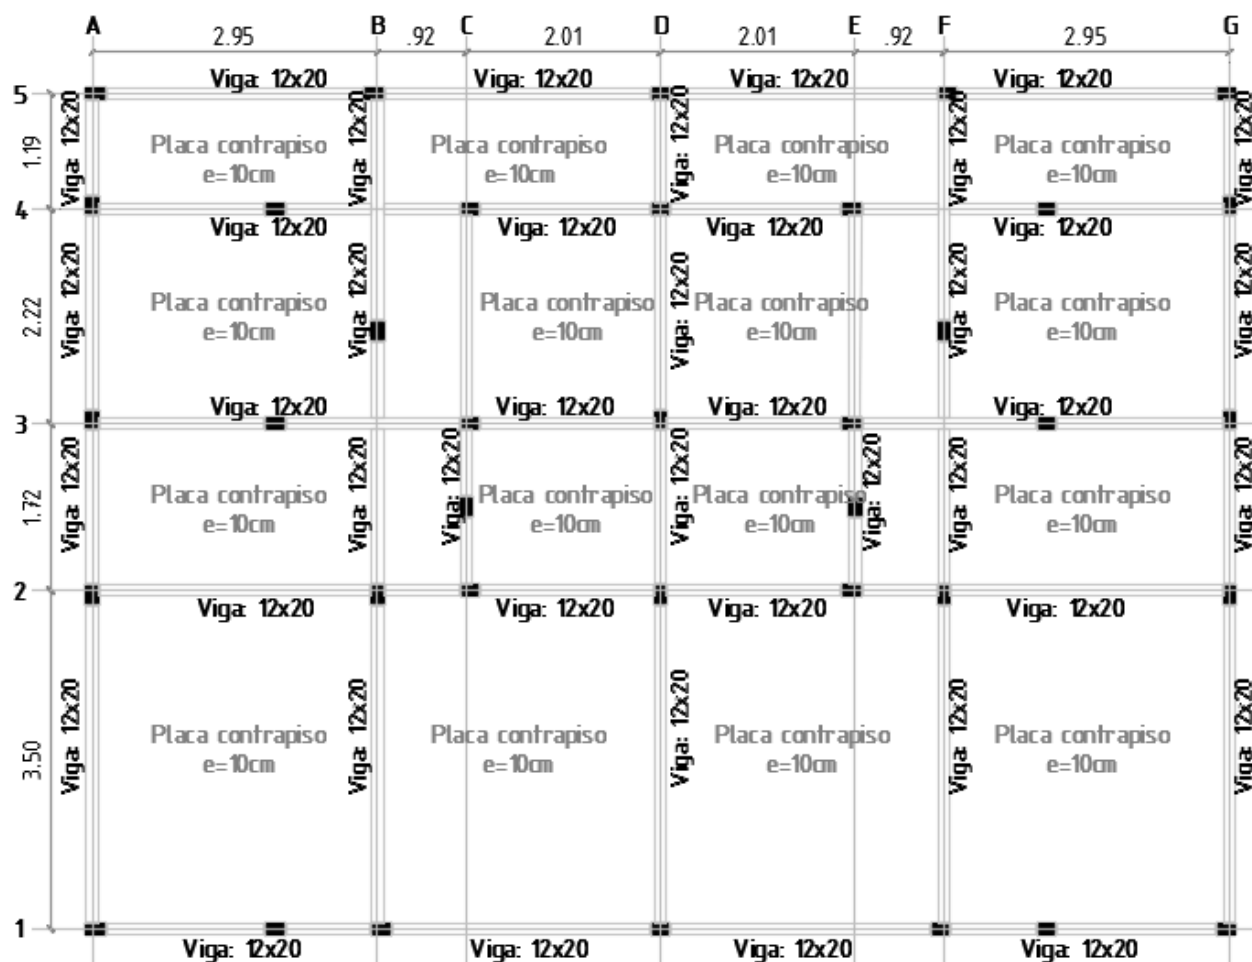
Detalle de cimentación continua para viviendas de mampostería confinada
